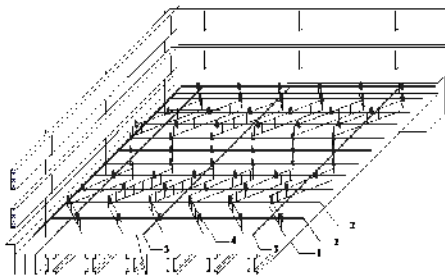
монтаж каркаса верхней арматурной сетки: 1
